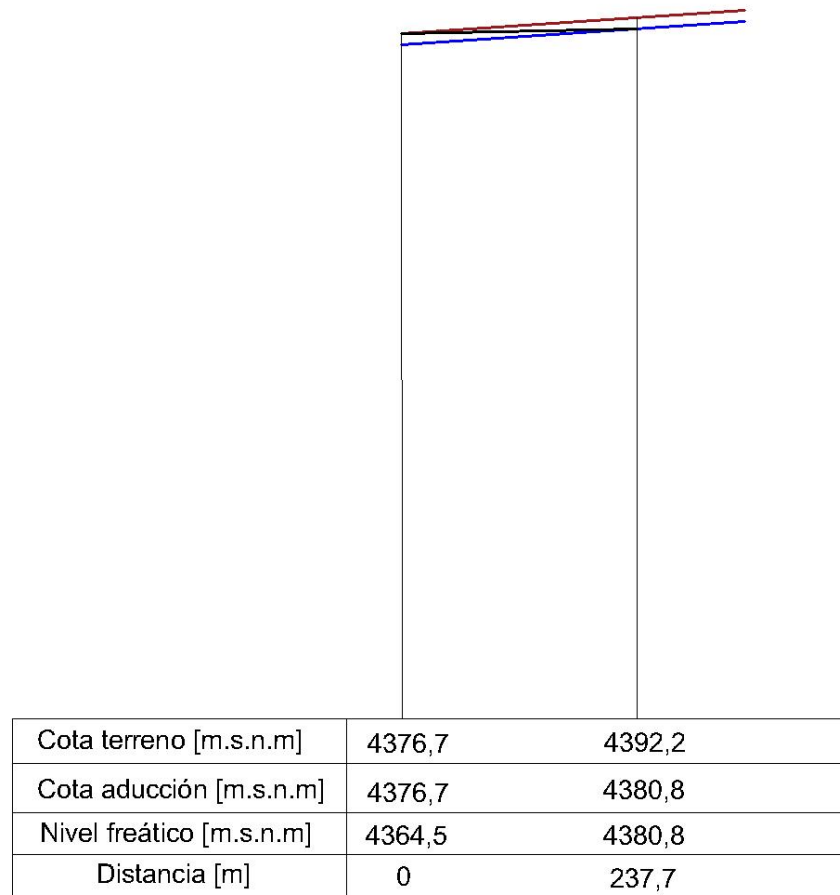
Perfil longitudinal de aducción en Quebrada 6.
